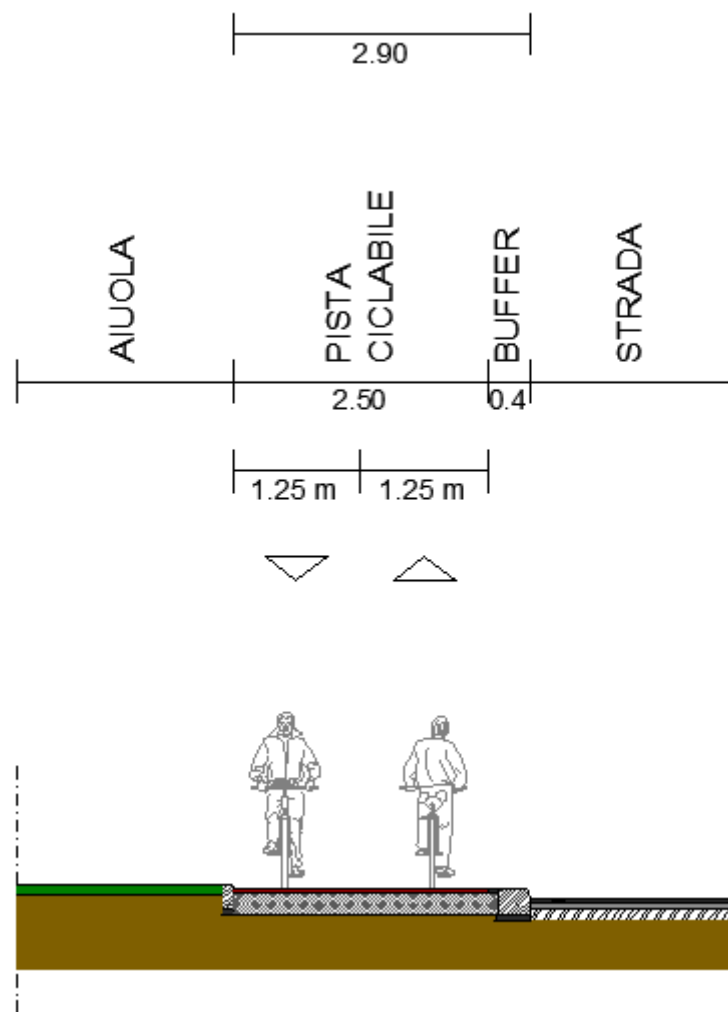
via Claudio, tratto nord, sezione trasversale di progetto (sez. F di fig. 12.1).
